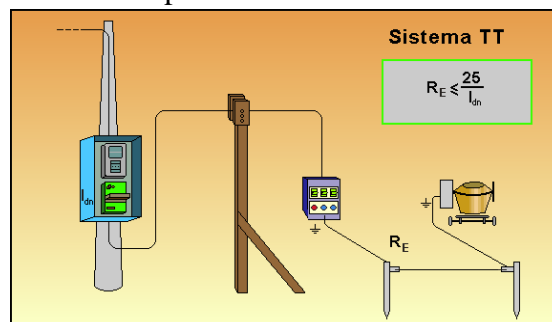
Alimentazione da rete pubblica (sistema TT)
